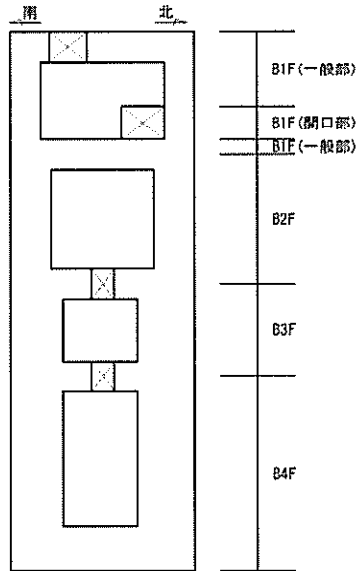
(4) 概略配筋図 (南北方向断面)
